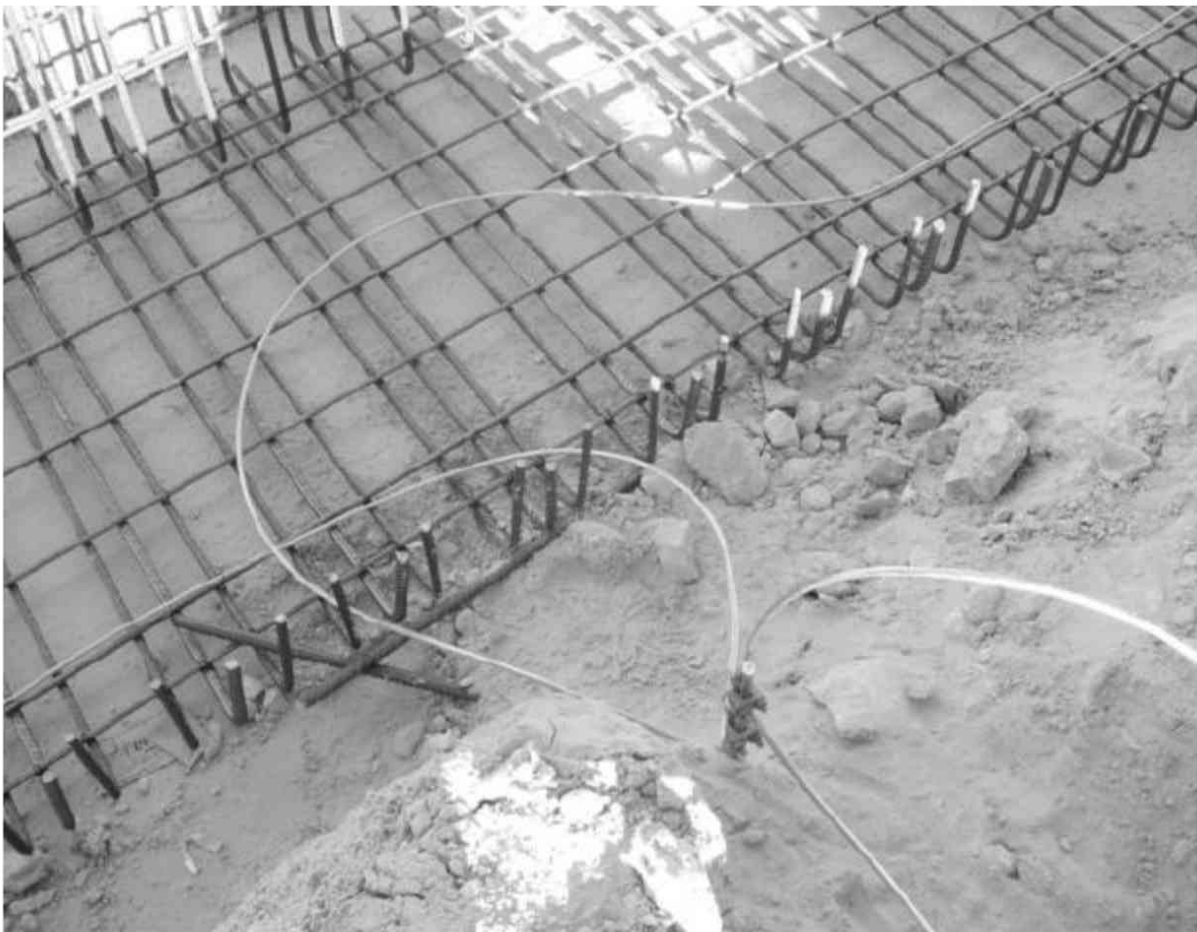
Conexión del electrodo enterrado (cable y pica) con la armadura del edificio
